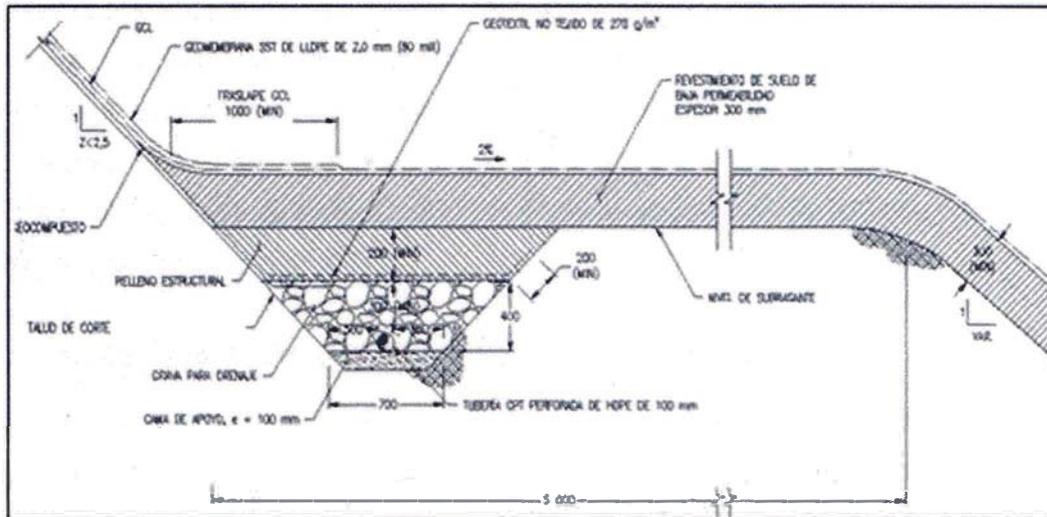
Detalle del sistema de sub drenaje en banquetas.
